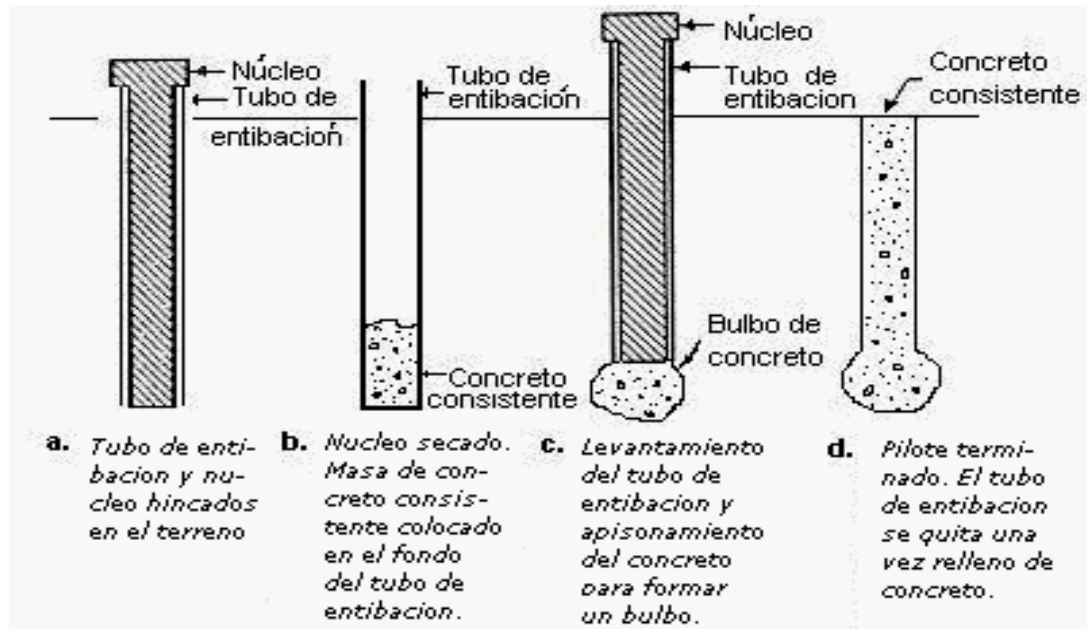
Construcción de un pilote de bulbo sin tubo de entibación permanente
